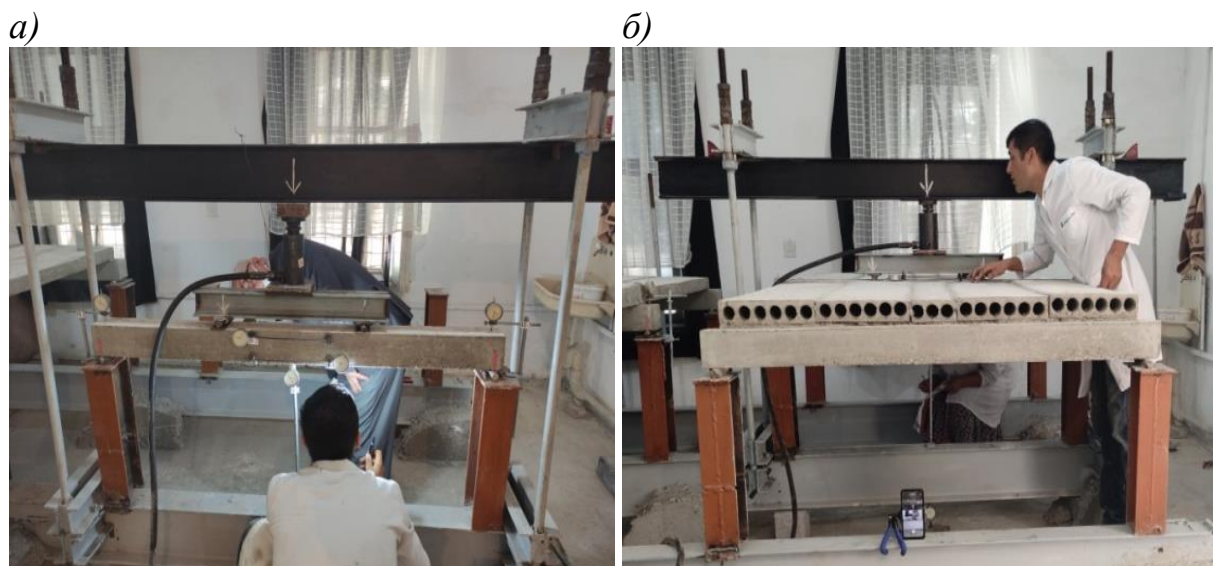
Экспериментальное исследование фрагмента перекрытия:
